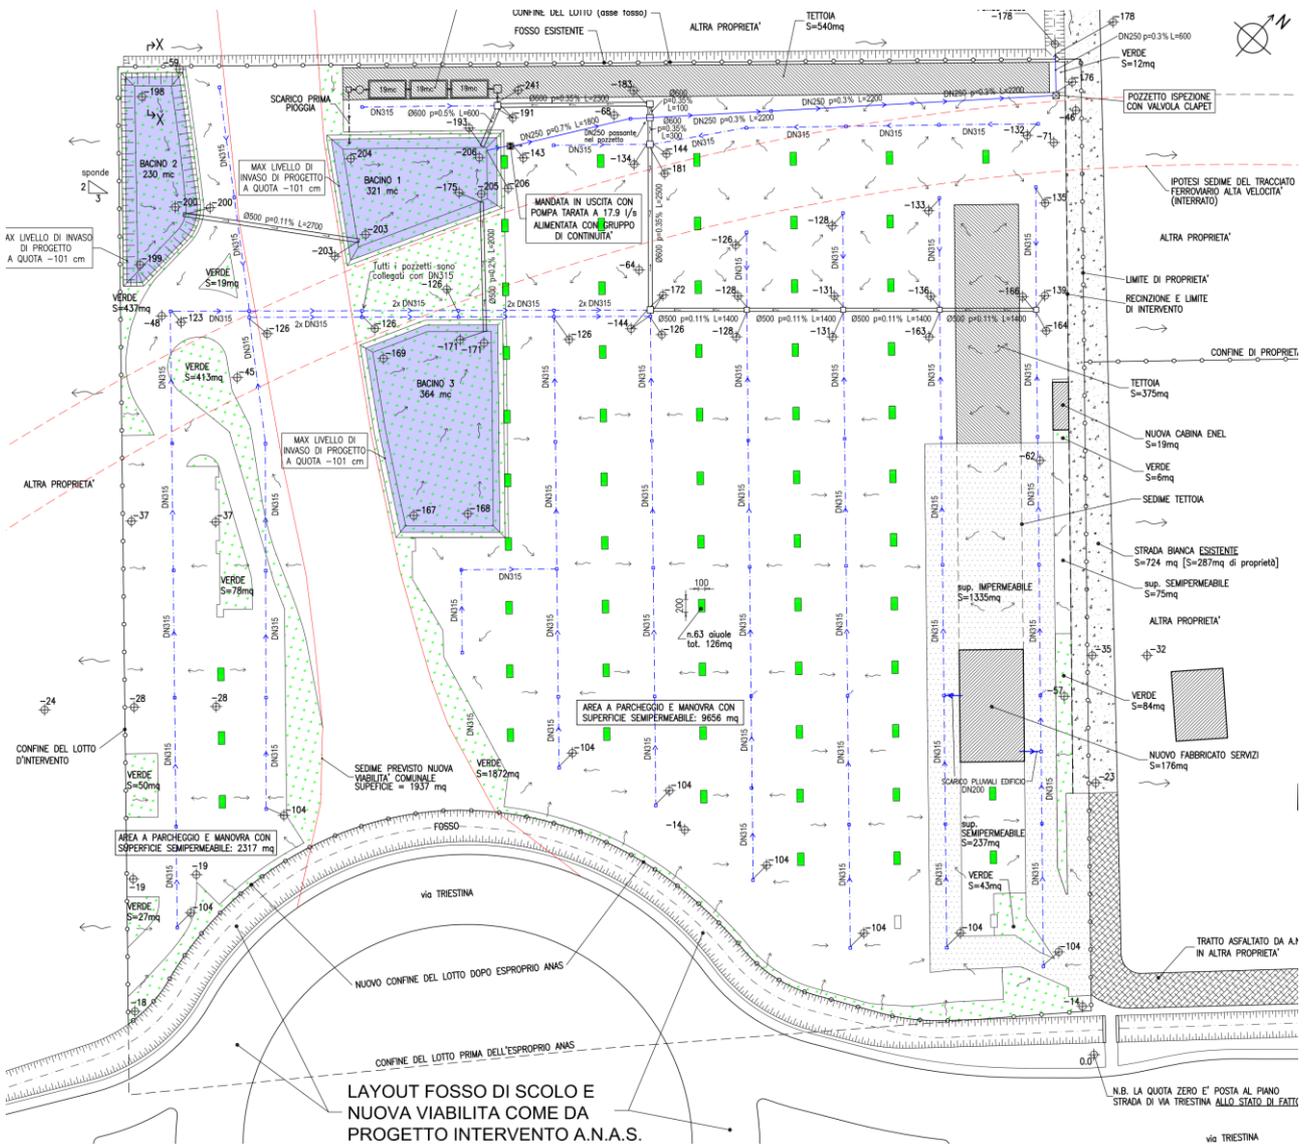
Pianta schema impianto laminazione acque meteoriche - lay-out di progetto successivo alla realizzazione della nuova viabilità comunale.
